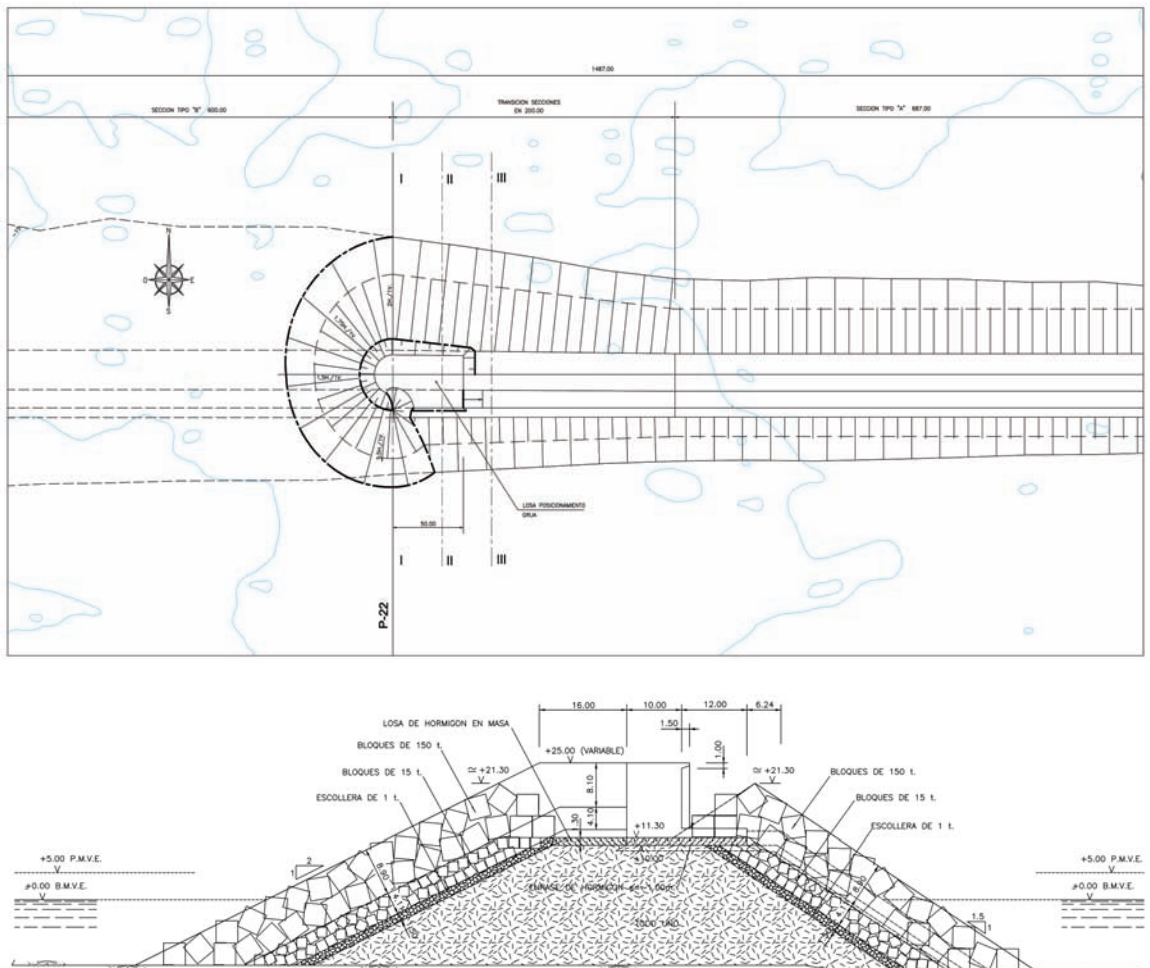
Oferta de Construcción. 1er Morro de Invernada. Planta y Sección tipo.
